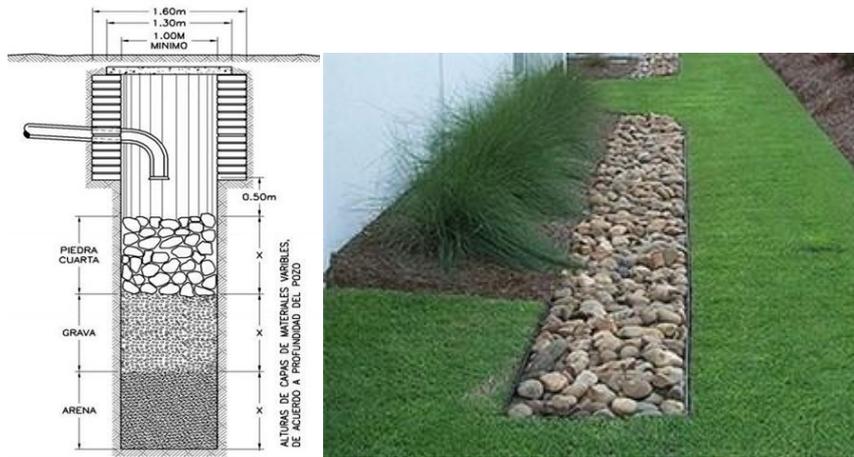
Esquema de pozo de infiltración. Fuente: ver anexo 1.
